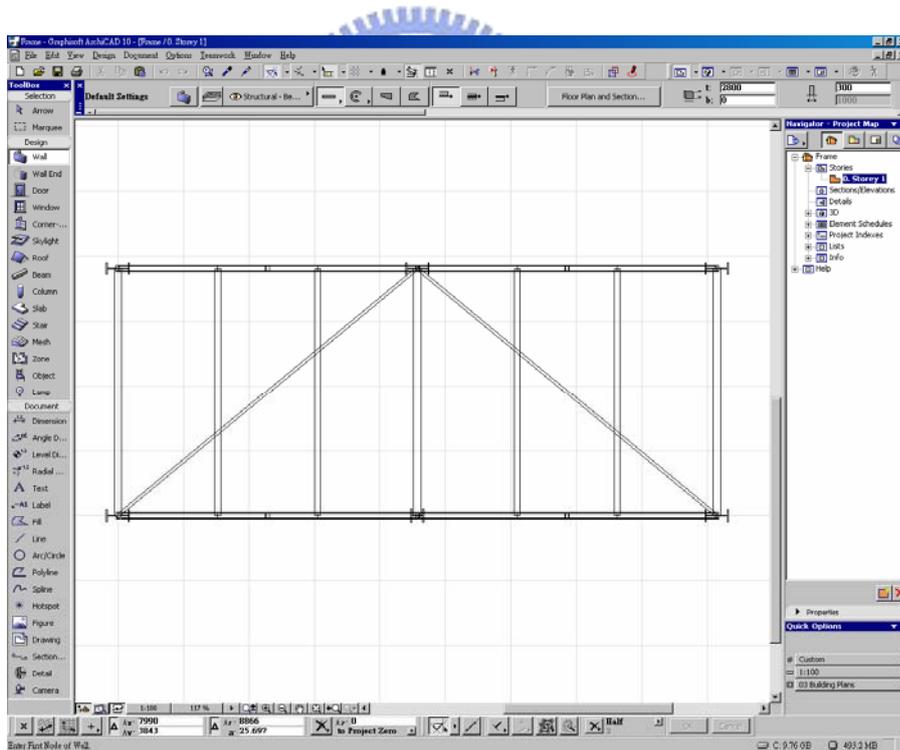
Frame 匯入 ArchiCAD 平面圖
